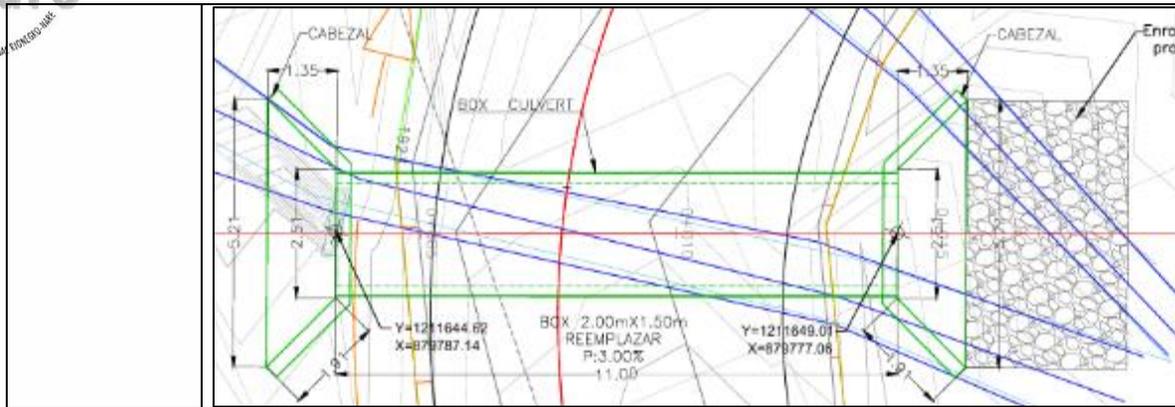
17 (73)		Tipo de la obra				Tubería abscisa K05+521
